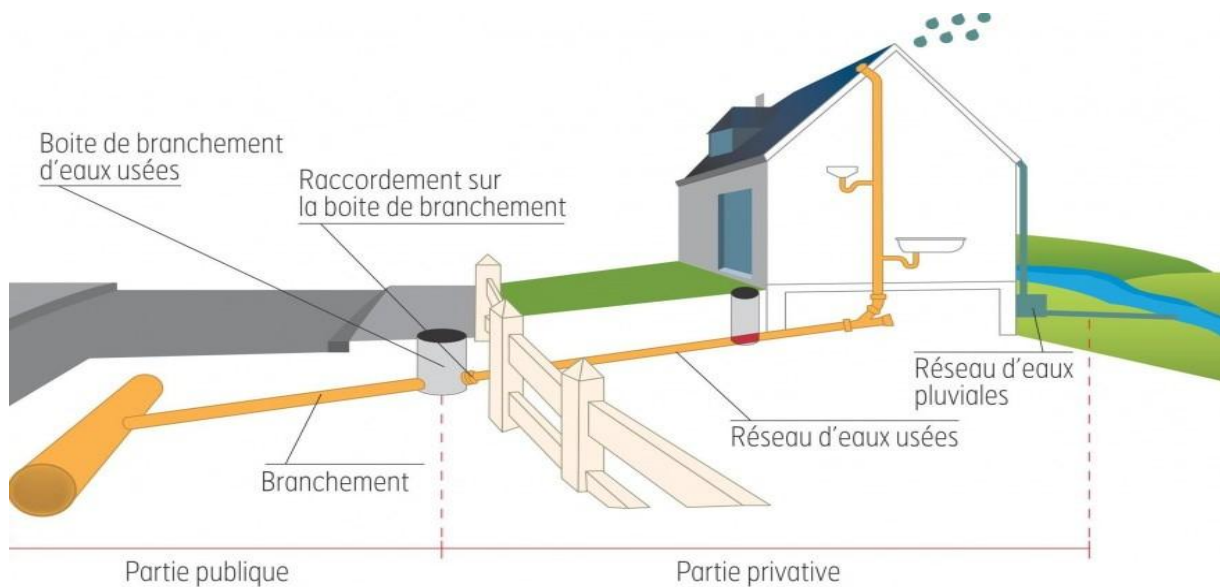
6. Boite de branchement (<http://www.dinan-agglomeration.fr>)
